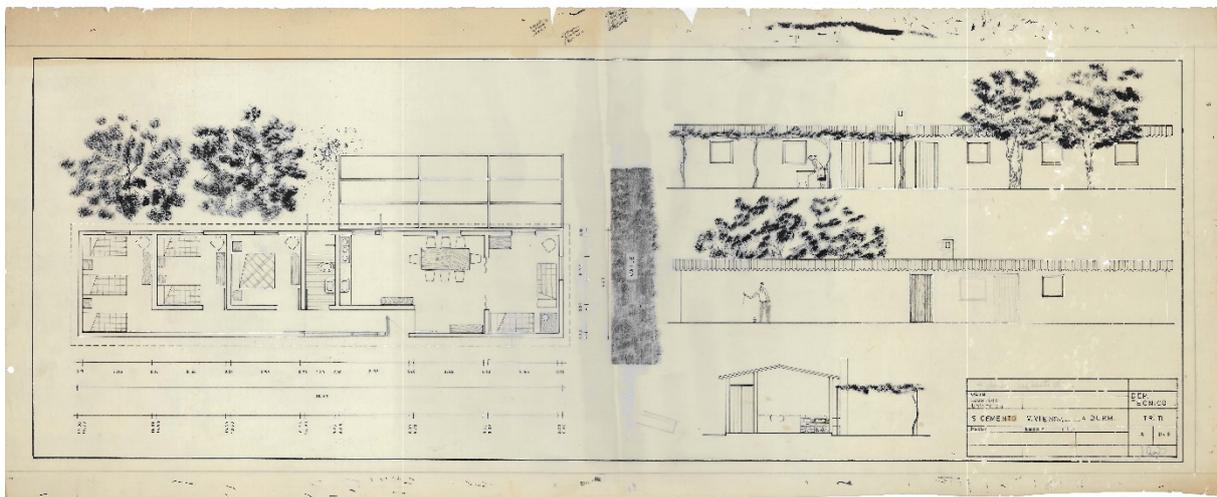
Planta tipo de 4 dormitorios utilizada en Casupá. Archivo Mevir.
